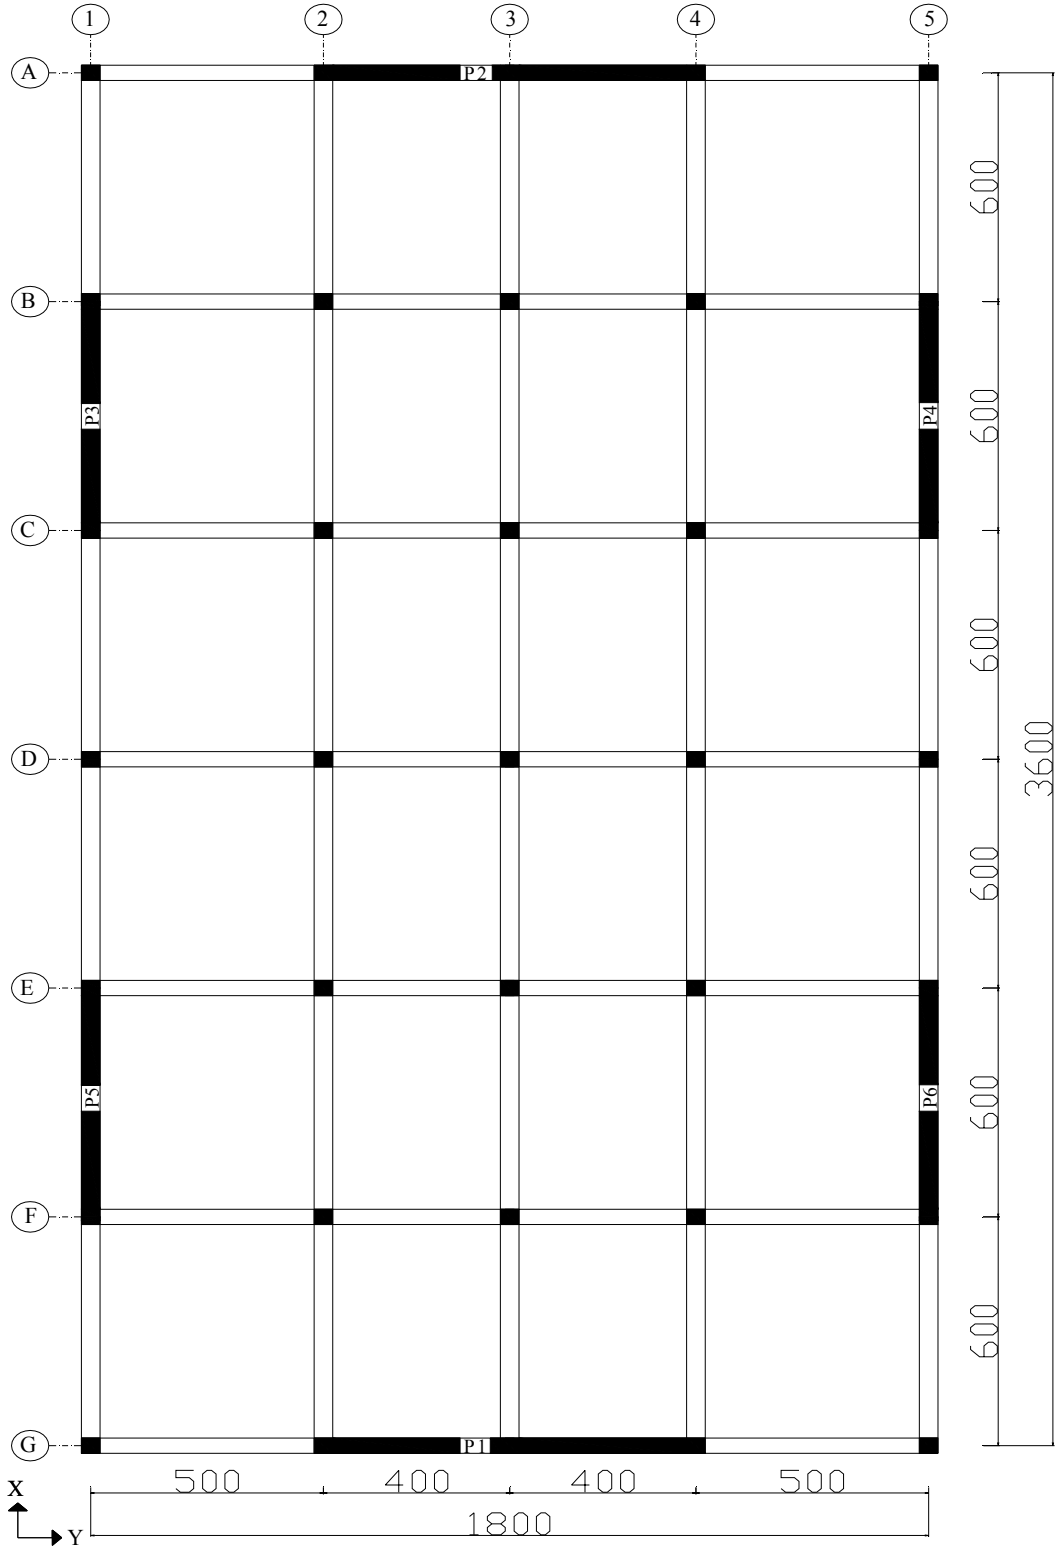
Örnek 5.12'nin kat kalıp planı
